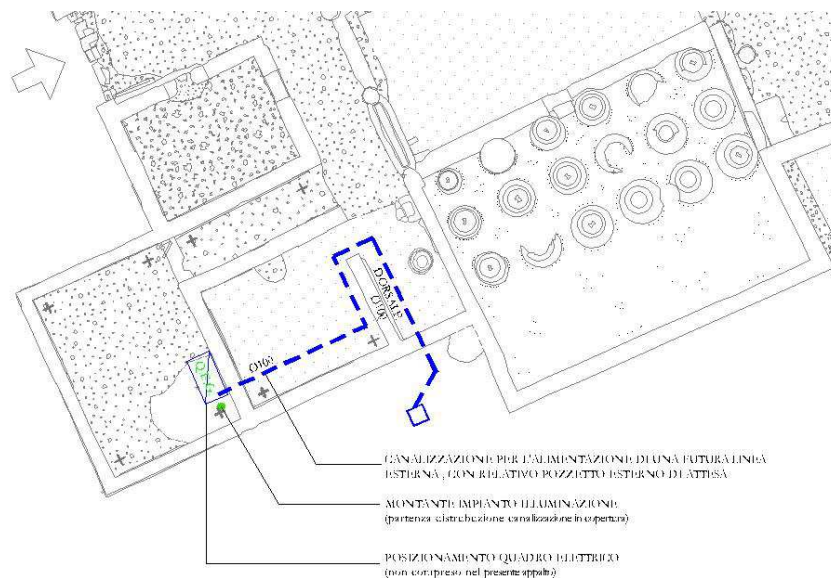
Distribuzione canalizzazione - Pianta Piano Terra
